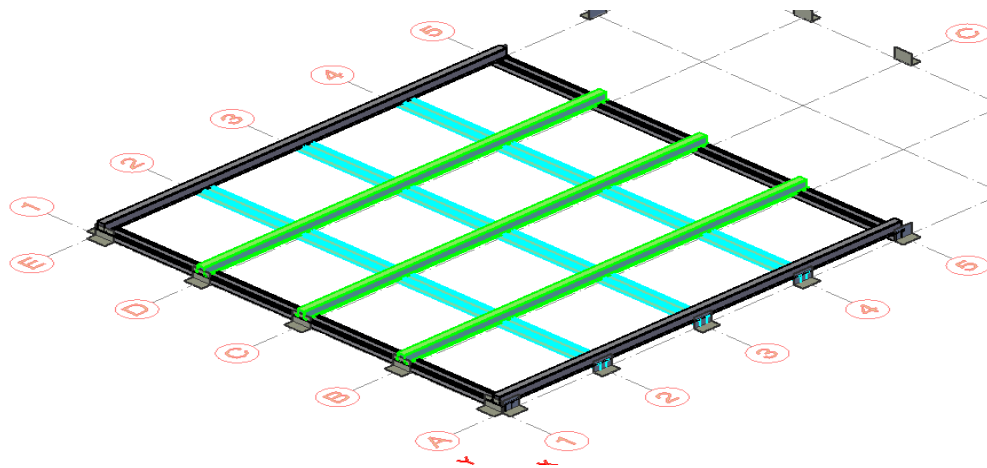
Isometría de Panel de 2.440mm x 2.460mm Colocado en Piso
